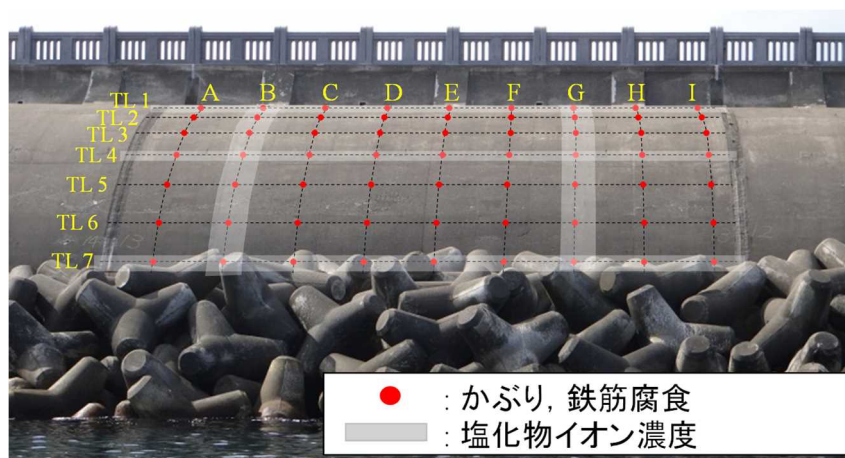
鉄筋かぶりと自然電位の測定位置（平面図）
